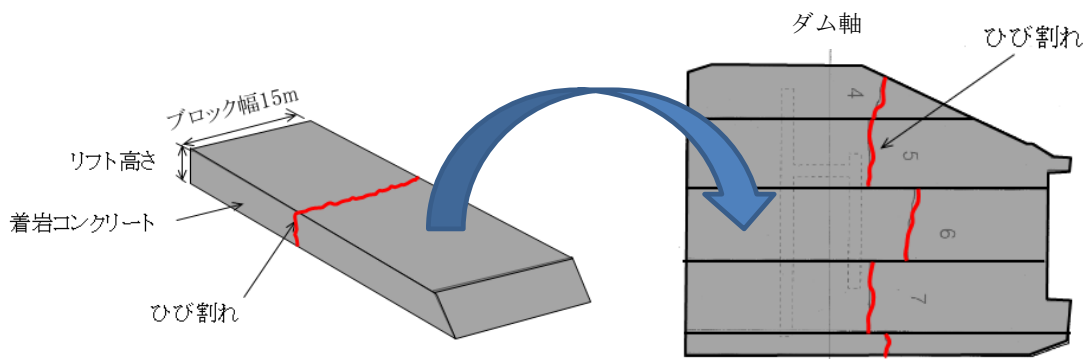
着岩コンクリートに発生したブロック分断ひび割れの例
